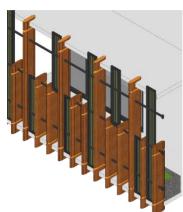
Tampak Bagian Kanan Bangunan dan penerapan secara detail
